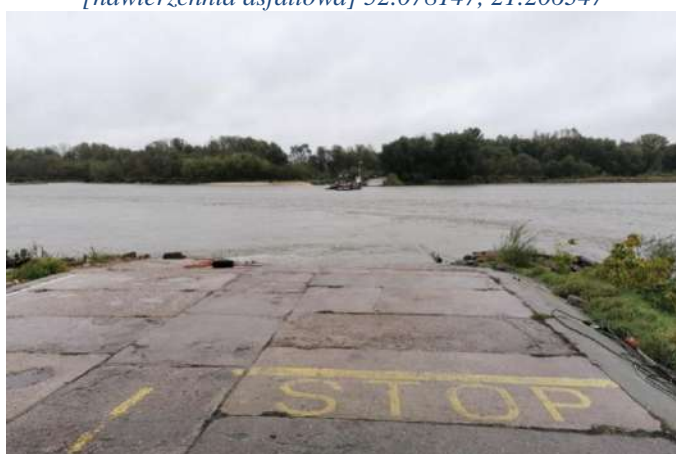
[w kierunku wschodnim] wjazd na prom przeprawy przez rzekę Wisłę w m. Gassy
